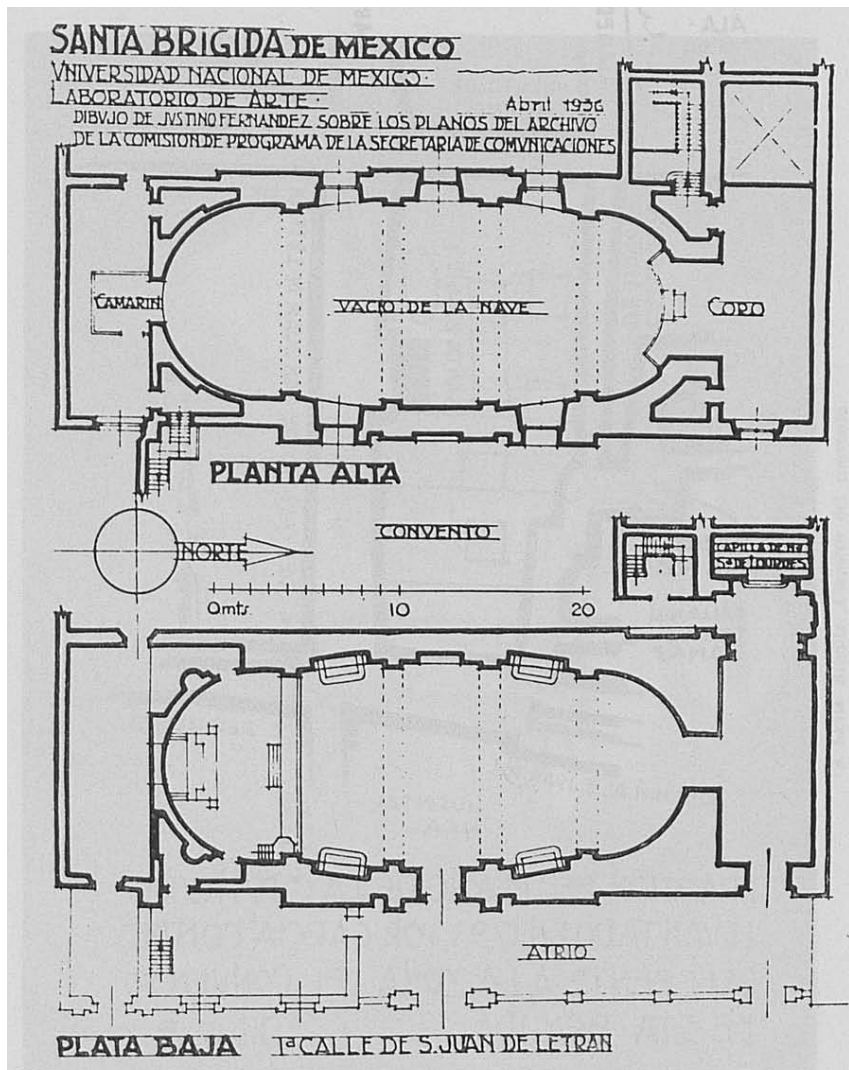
(Fernández 12) Planos de la planta alta y baja del convento de Santa Brígida
